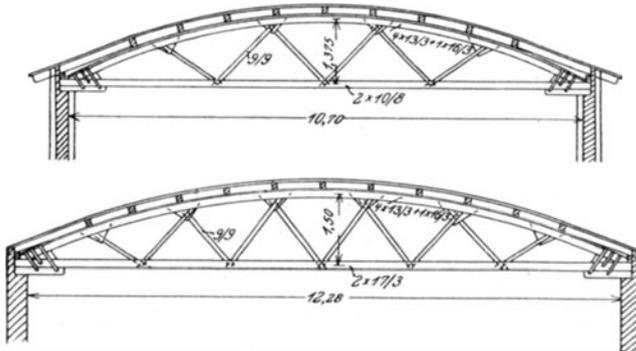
Dachkonstruktionen für die Dampf- und Handwäscherei Wiesenhaus in Hundsfeld.
